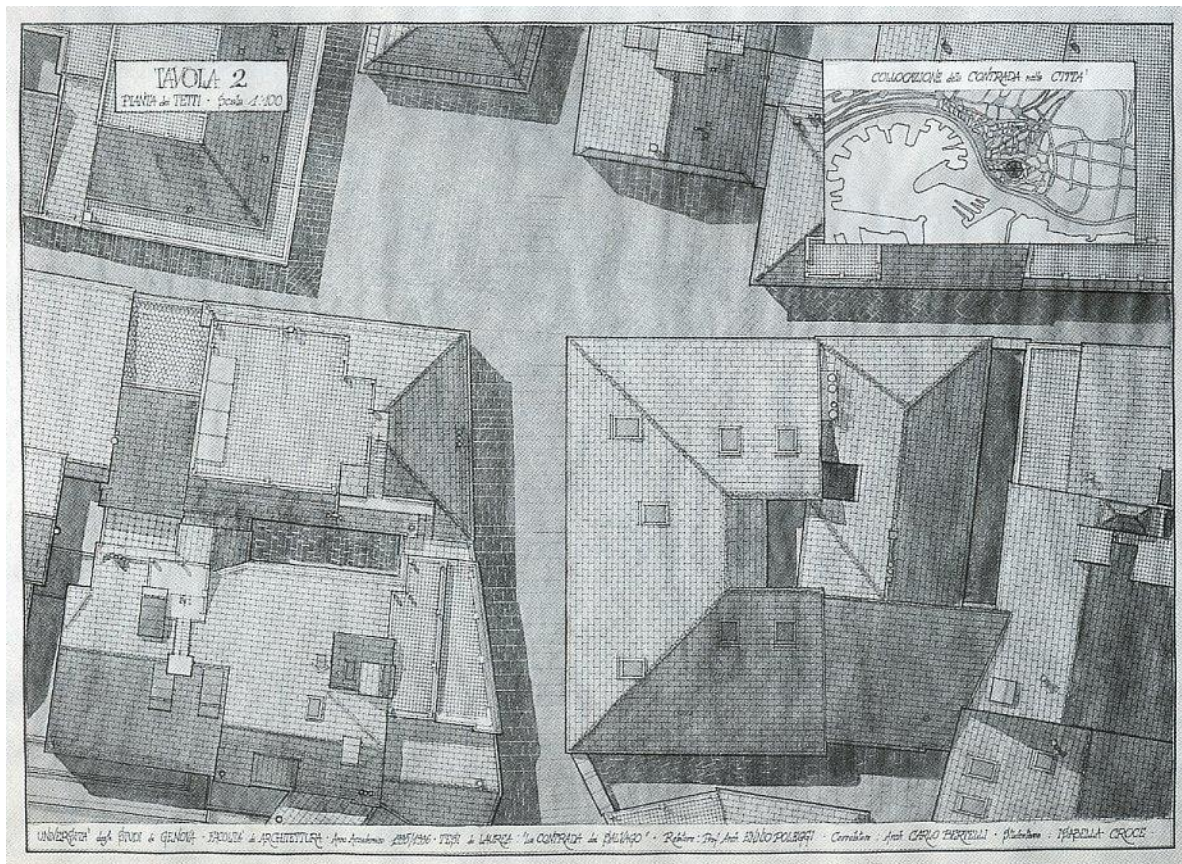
Pianta delle coperture degli edifici che si affacciano sulla Piazza dei Salvago (attuale Piazza S. Bernardo).
